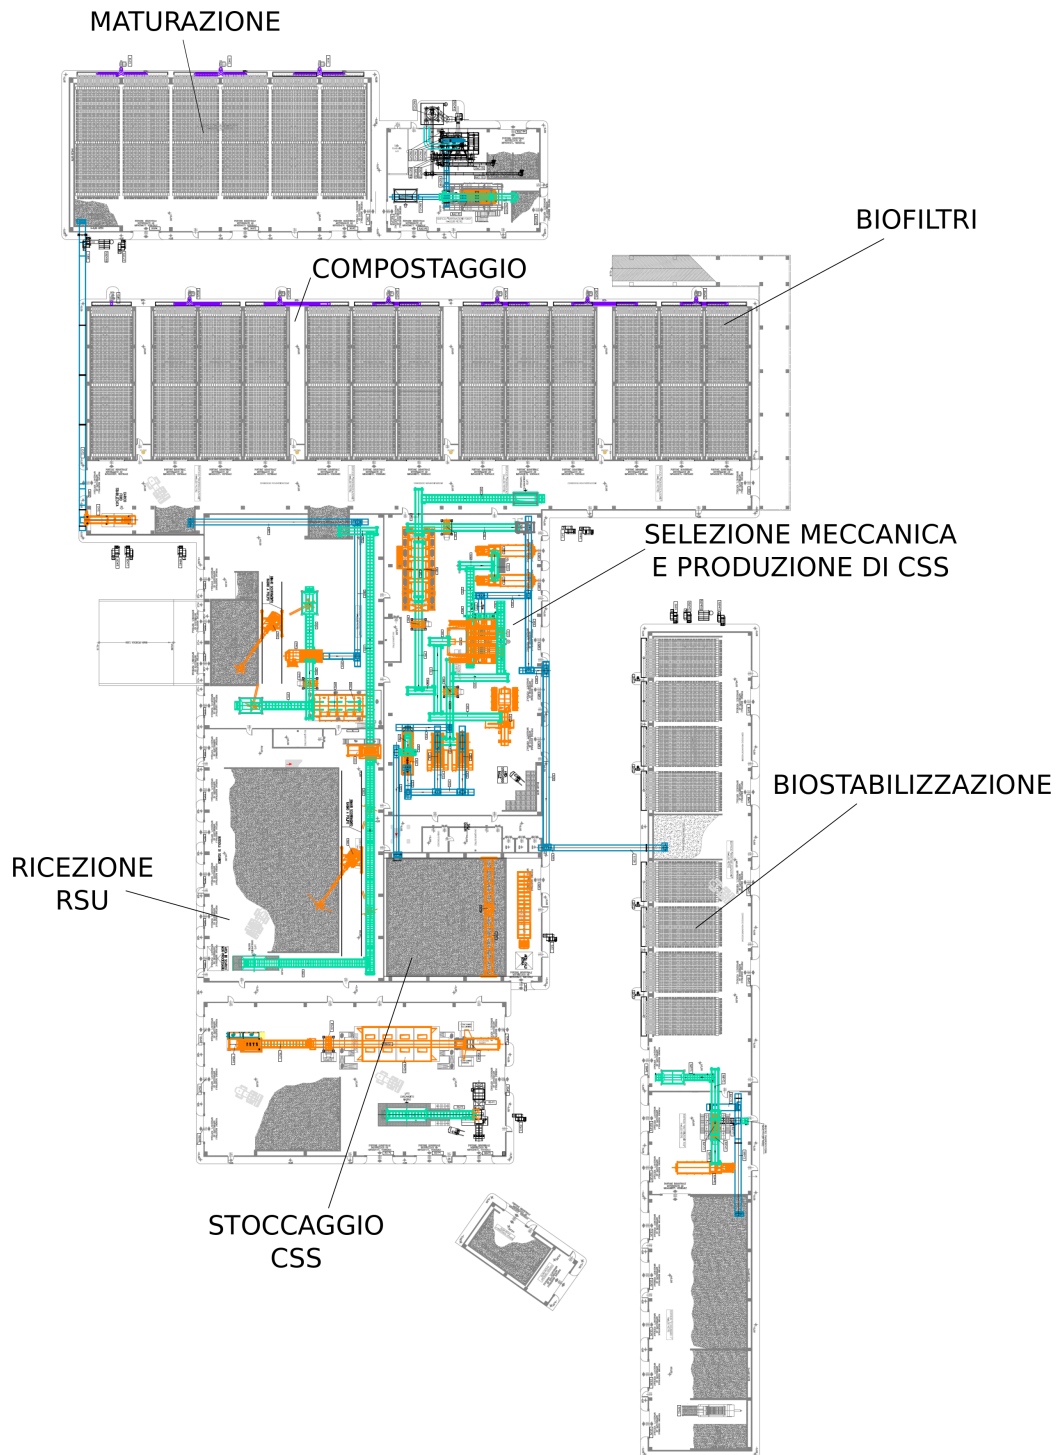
Planimetria di un ipotetico impianto MBT.
